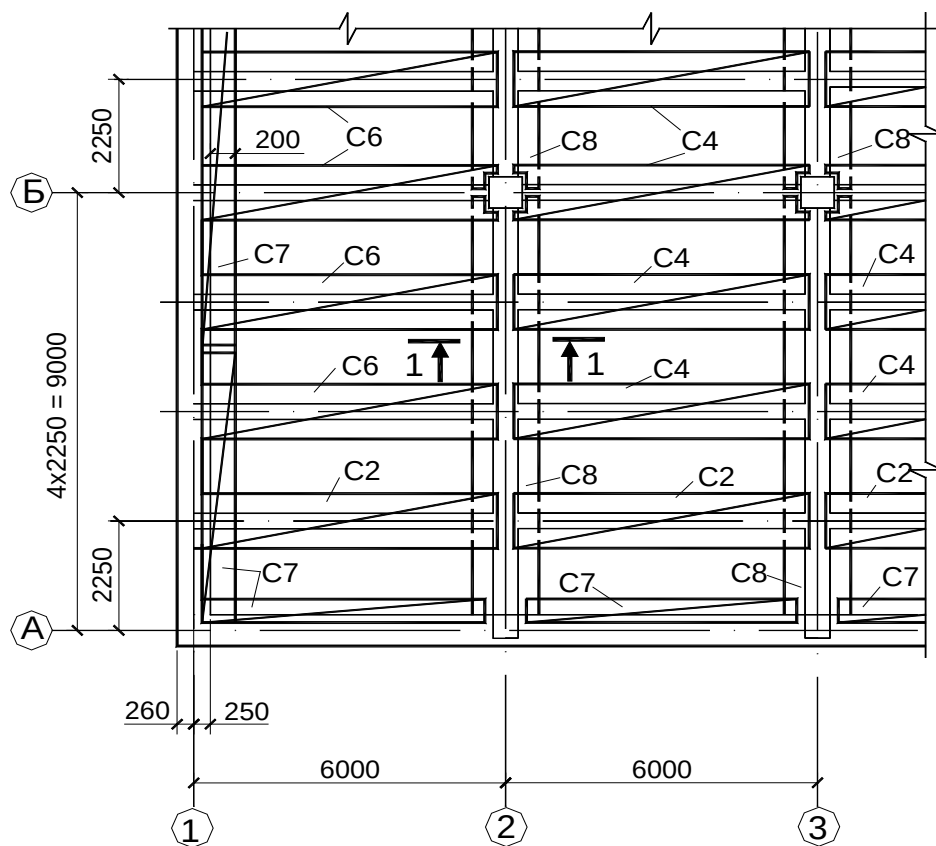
Армирование плиты сварными сетками с поперечным расположением рабочих стержней (вариант II). Раскладка нижних сеток
